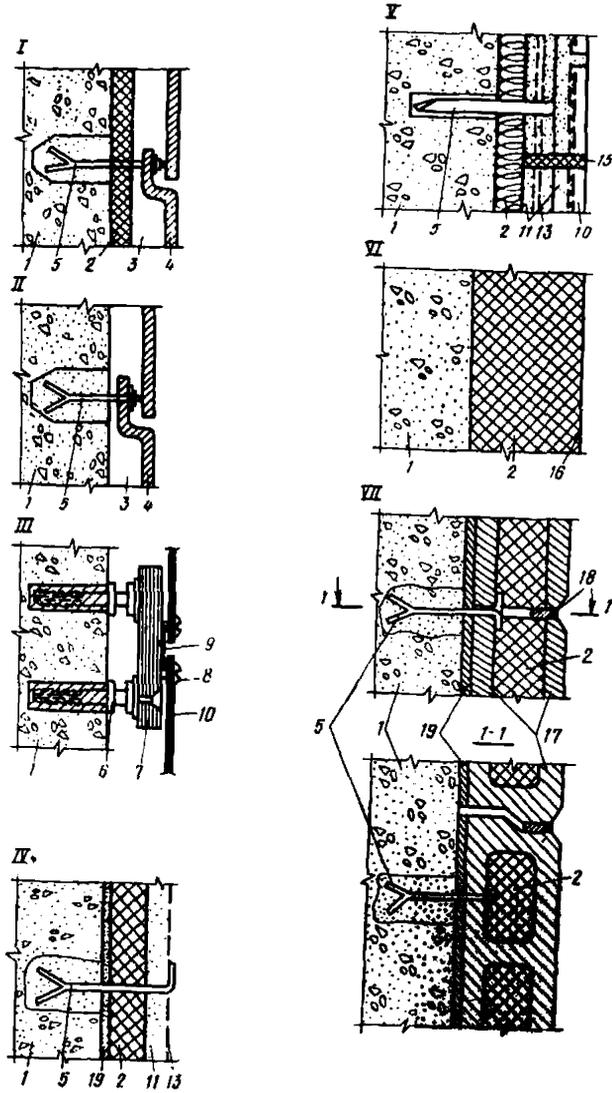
Принципиальные схемы технических решений дополнительного утепления панелей наружных стен снаружи
